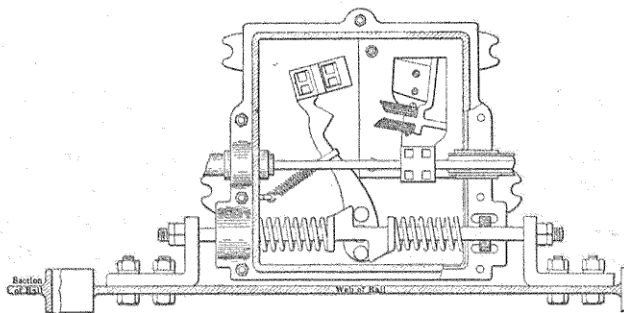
Coupe horizontale du 3^e rail système Willard au droit d'un appareil.
